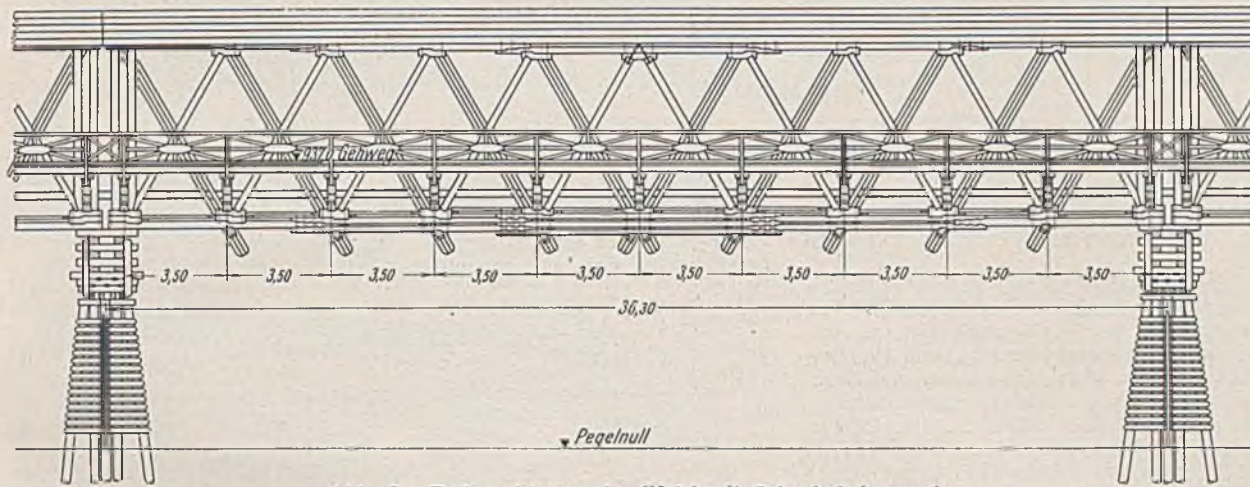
Fachwerkträger der Weichselbrücke bei Annapol.
